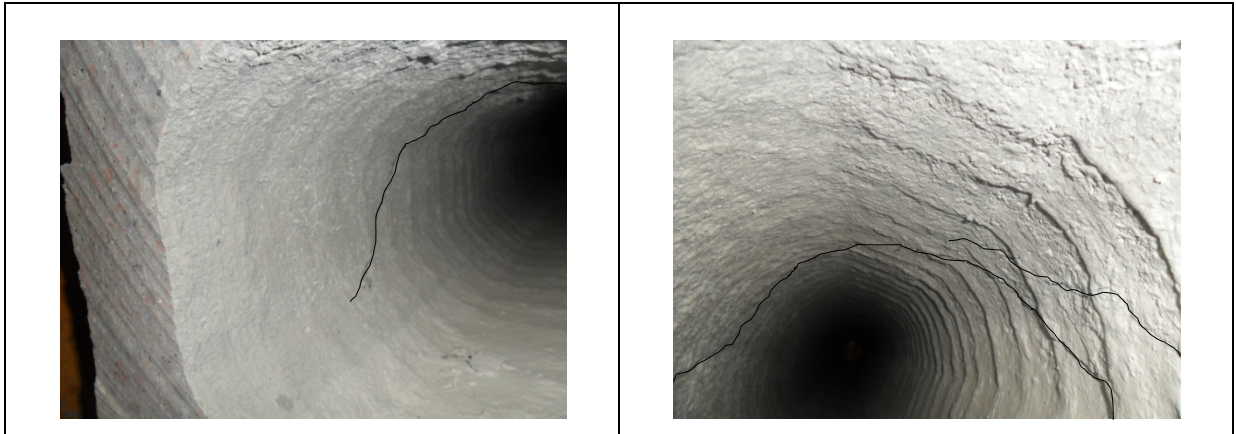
FISSURAS NAS NERVURAS DAS LAJES LA003-A APÓS OS ENSAIOS.
